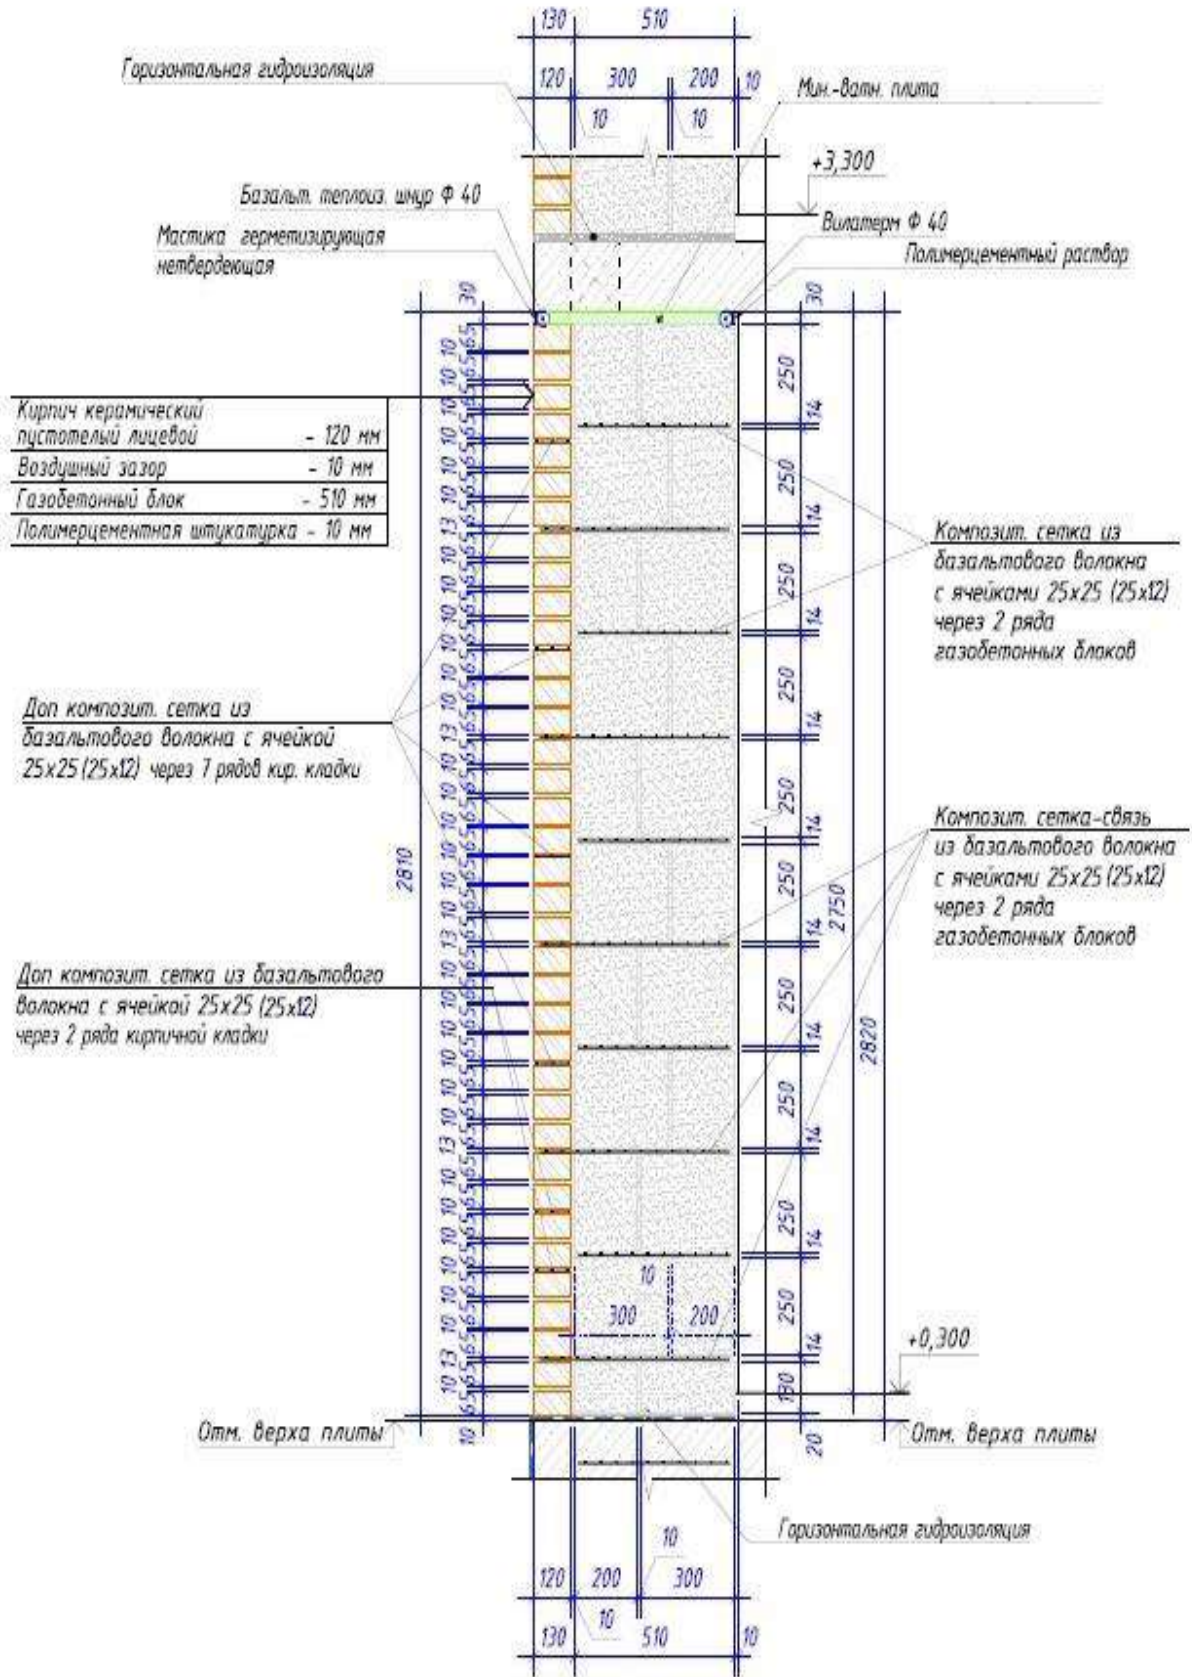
Конструкция двухслойной стены с внутренним слоем из ячеистобетонных блоков
